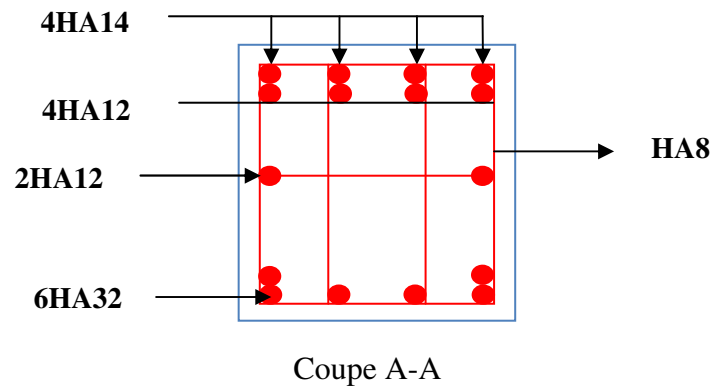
Schéma de ferrailage de la poutre de rigidité.
